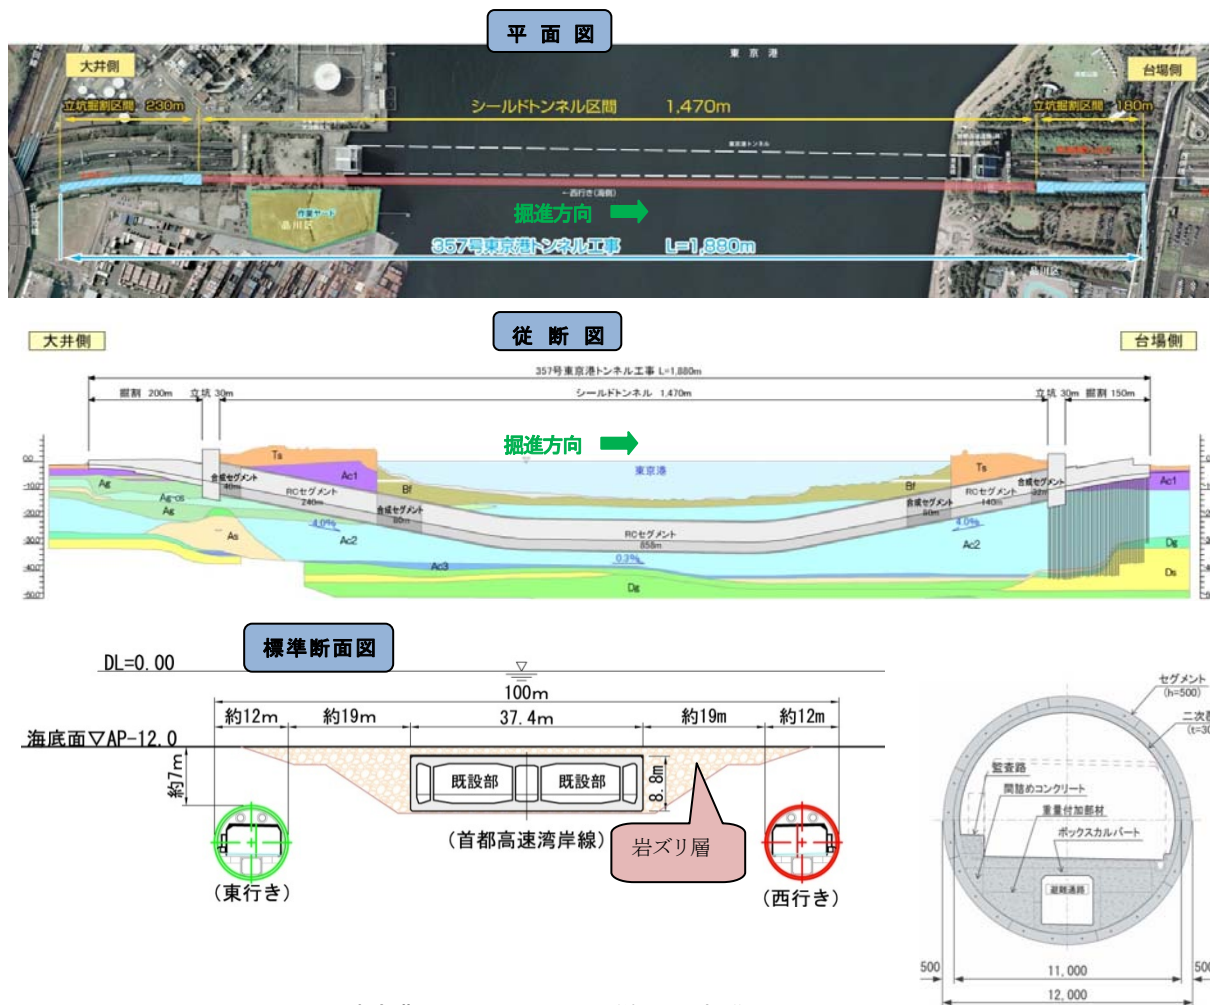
東京港トンネル 平面図・縦断面図・標準断面図
